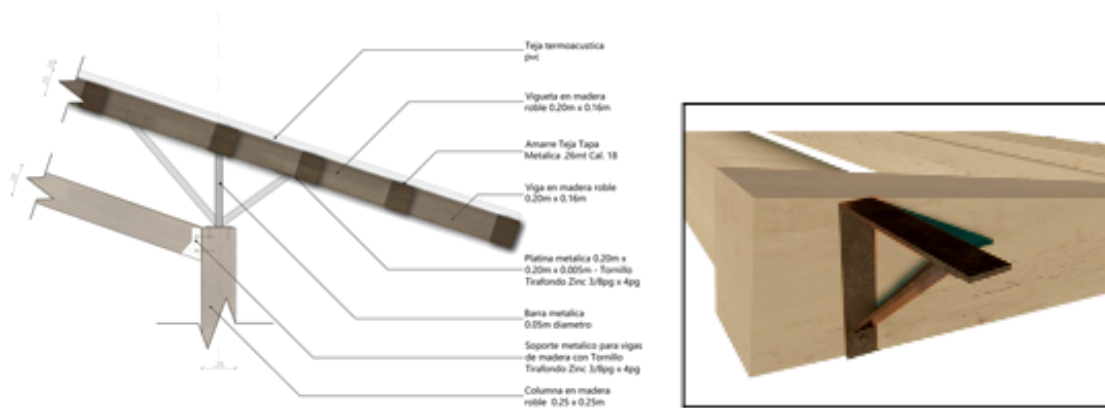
Detalle estructural para cubierta. Elaboración propia.
